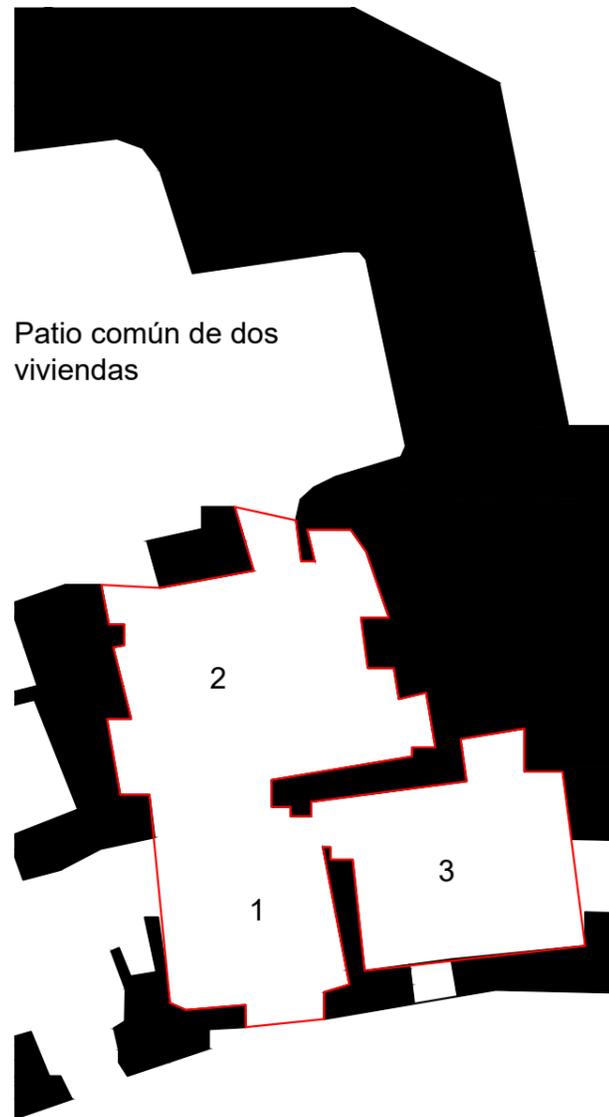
Planimetría fuente propia, coves del Batá, Paterna
